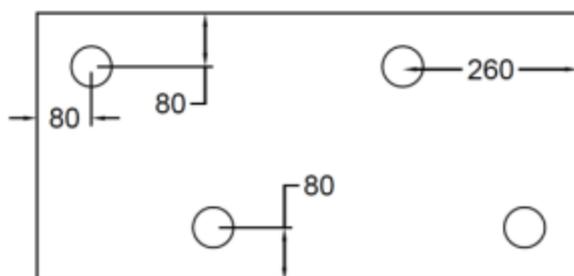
Plans de chevillage - panneaux PAVAWALL-BLOC de dimensions 400 × 600 mm
